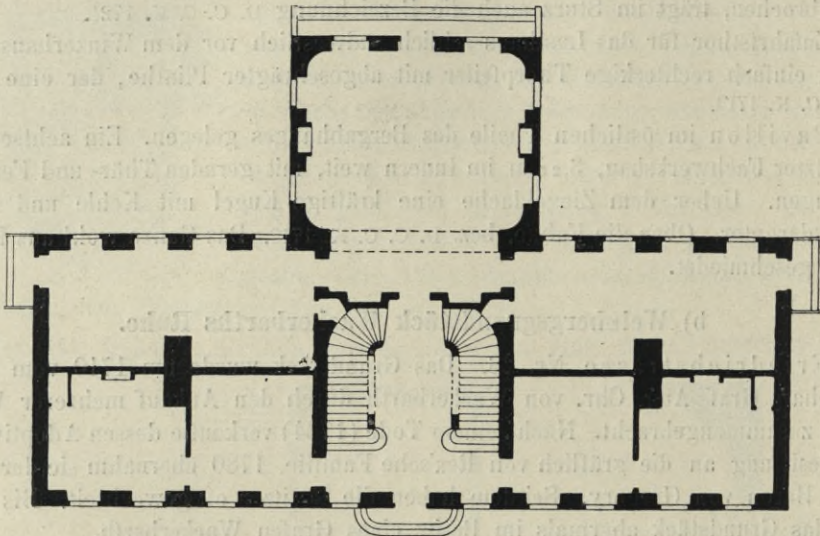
Niederlössnitz, Wackerbarths Ruhe, Grundriss des Erdgeschosses.
